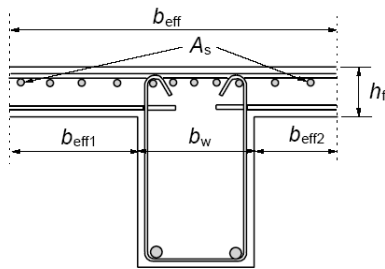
Anordnung der Zugbewehrung im Plattenbalkenquerschnitt
